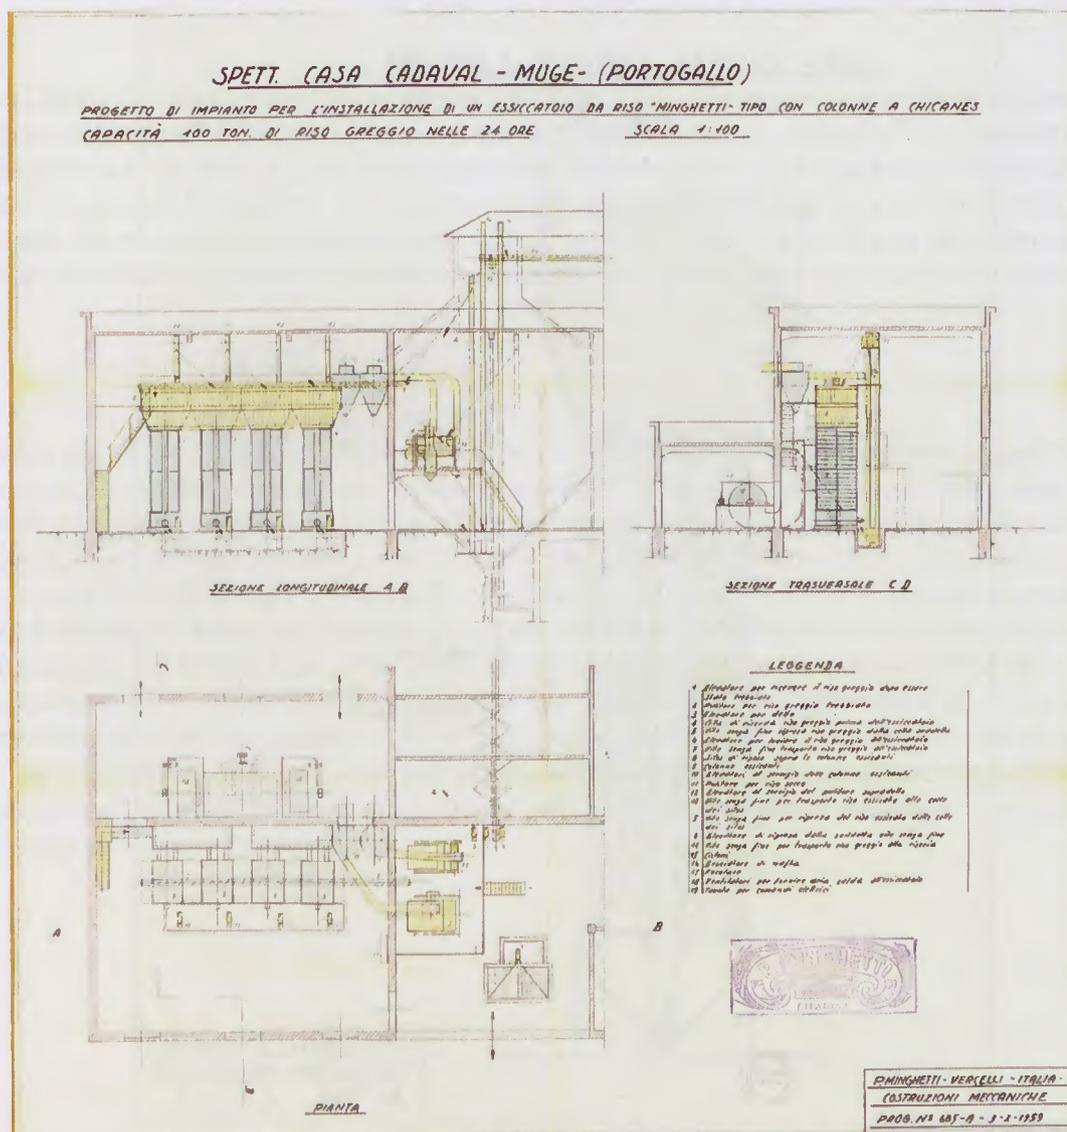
Projecto do secador artificial de arroz tipo de colunas à Chicanes. Capacidade de 1000kg/hora, para a Casa Cadaval. Esc.: 1:100. Planta, corte longitudinal e corte transversal. P. Minghetti, Construção Mecânica. Vercelli, Itália. Des. 685-A. 3-2-1959. Original colorido sobre desenho reproduzido. ACC -Proc.º Fábrica do Arroz.
